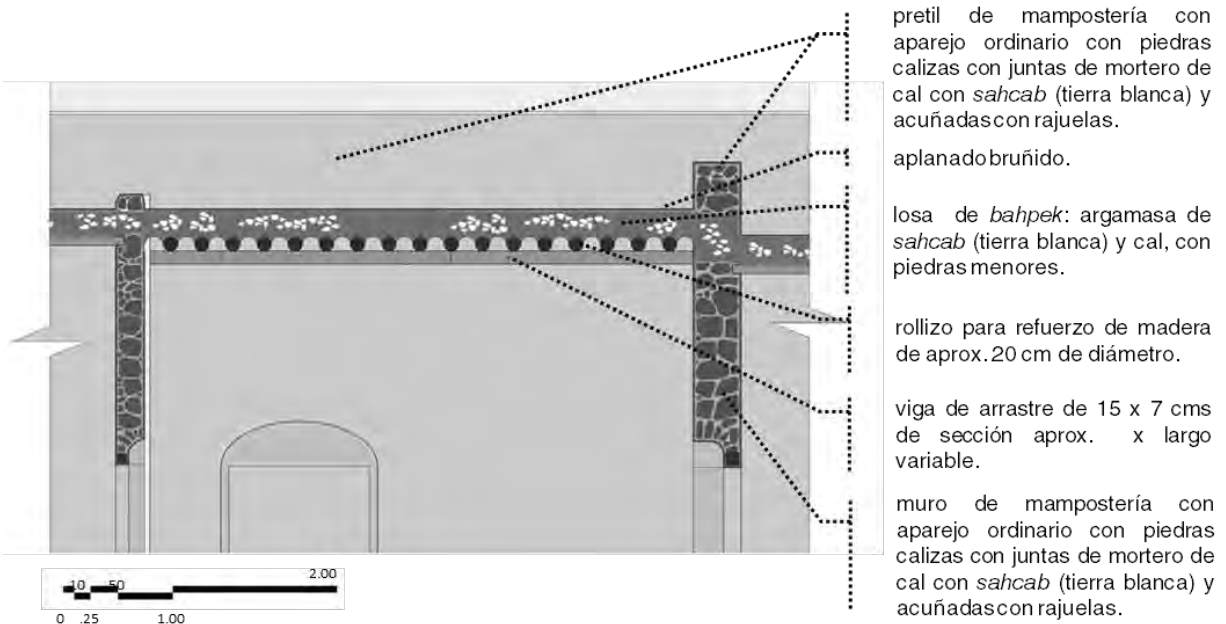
Corte por fachada de un techo solucionado con vigas de rollizos de madera sobre viga de arrastre. Con este sistema se solucionaban los espacios más sencillos o de servicio, su manufactura resultaba más económica que las demás. Fuente: hipótesis y croquis del autor, en base a levantamiento arquitectónico en el inmueble 093, 2012.
